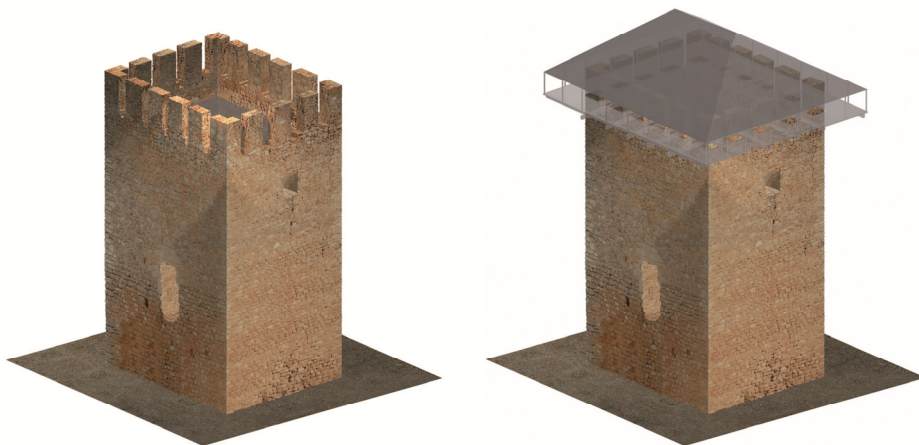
Modelización para un posible sistema de cubierta de la torre de Piqueras (Ruiz Checa)
